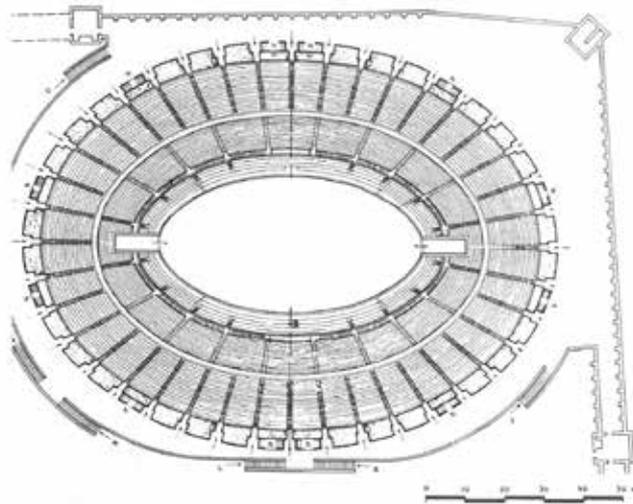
Pianta dell'anfiteatro di Pompei.
